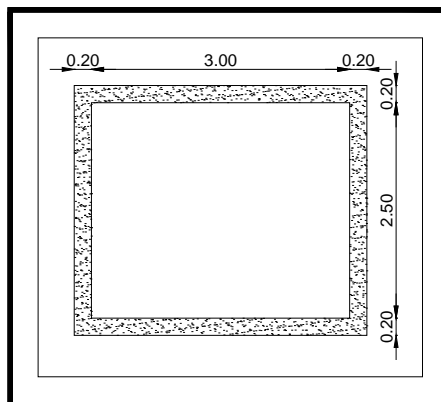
Vista en Planta del Tanque de Almacenamiento
